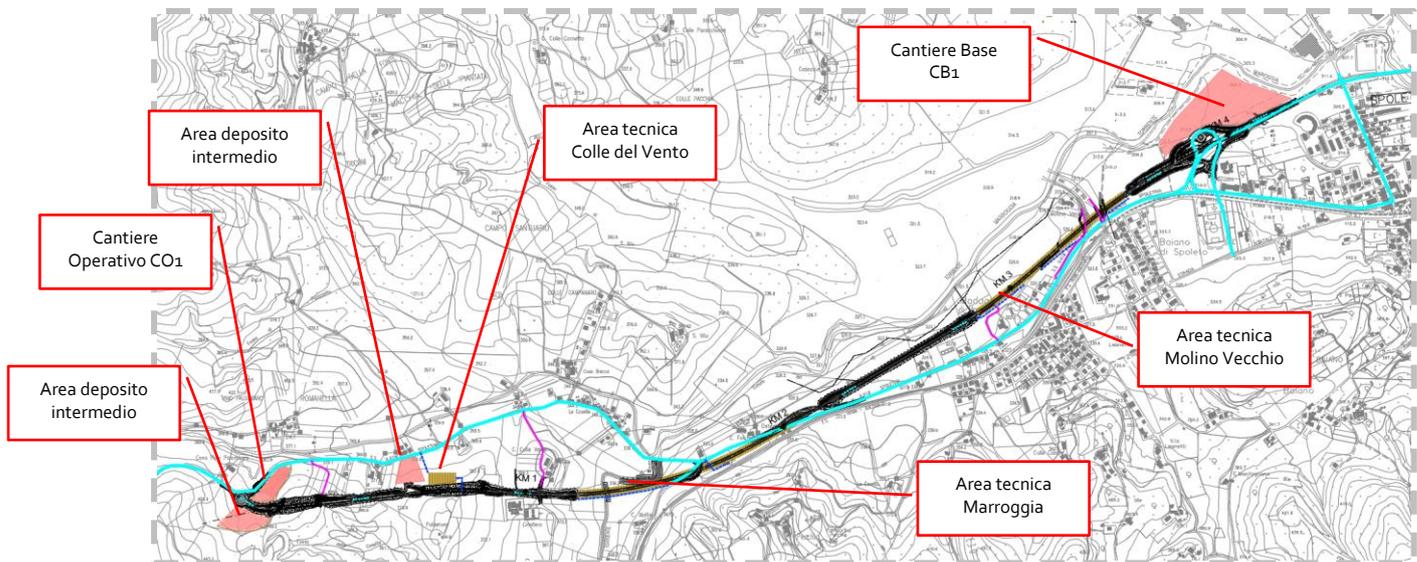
Planimetria con individuazione dei cantieri base e operativi.
